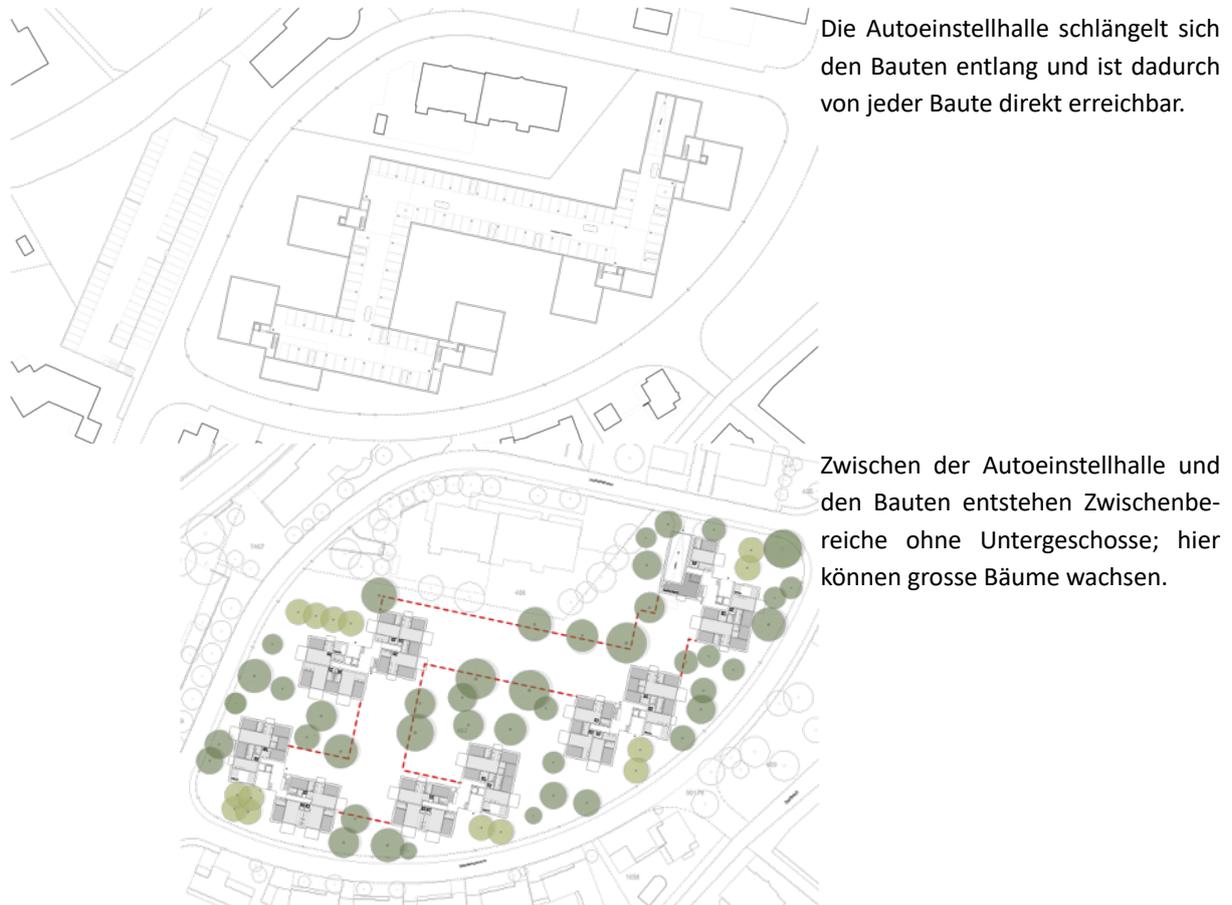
Situation Untergeschoss mit Parkierung und mit Bäumen überlagert
